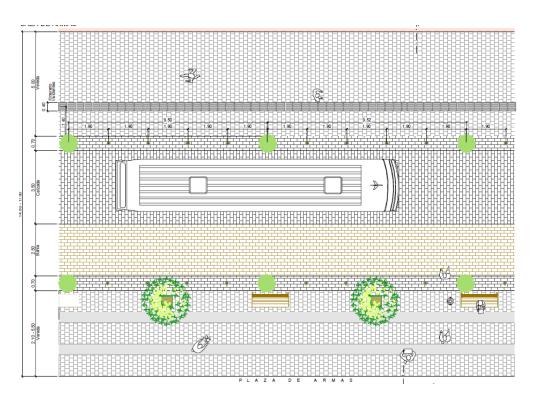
Detalle planta propuesta peatonalización Plaza de Armas
